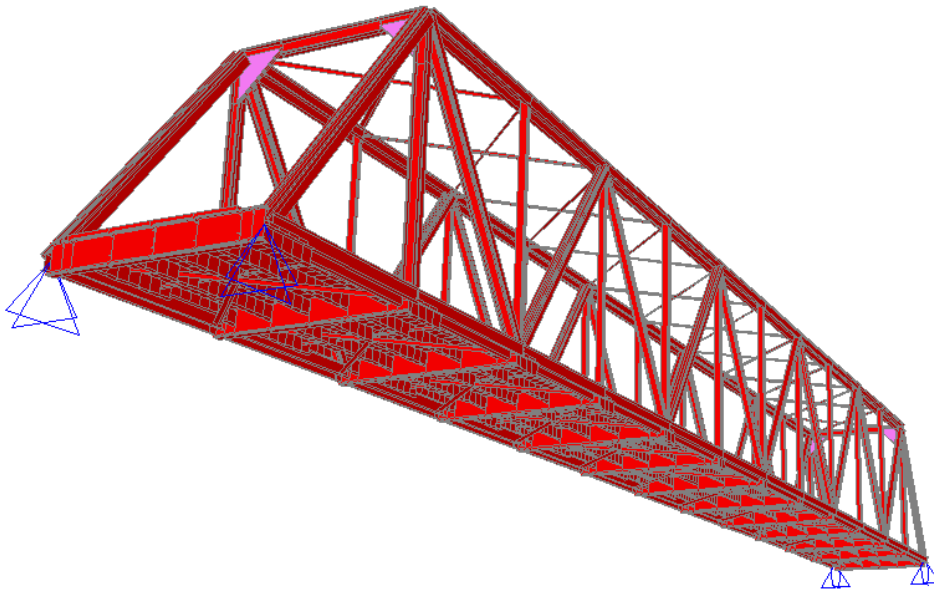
Vista del modelo en elementos finitos del puente metálico
